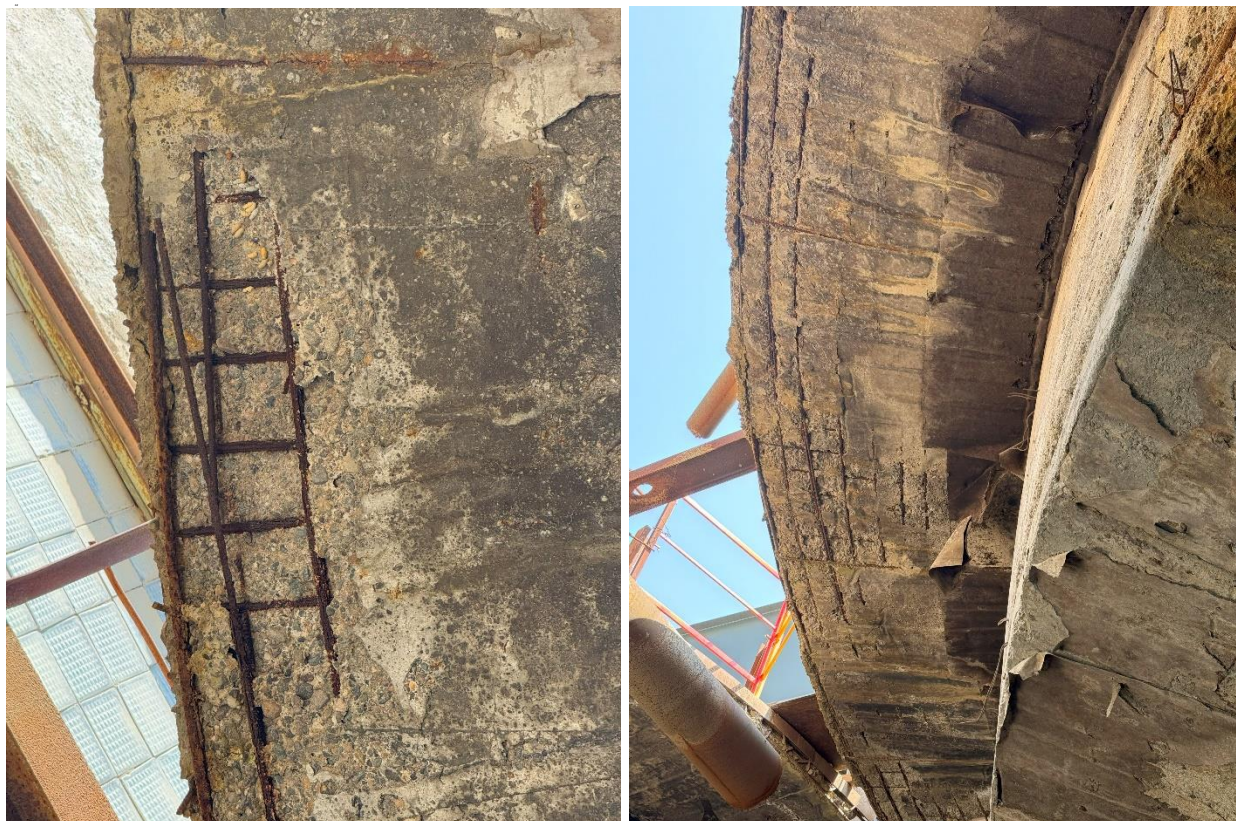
Разрушение наружной гидроизоляции чаши. Разрушение наружного защитного слоя бетона чаши
